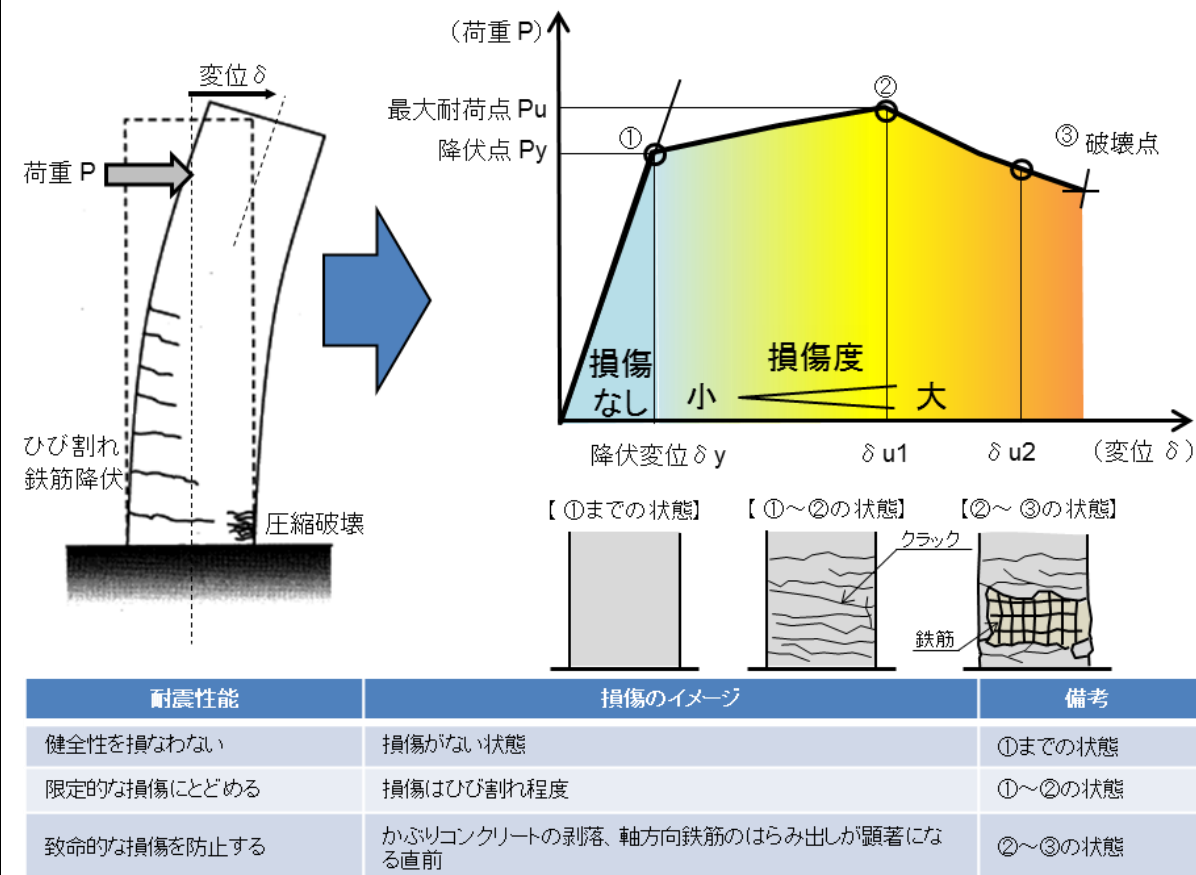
施設の損傷状態と耐震性能のイメージ【鉄筋コンクリート部材(曲げ破壊型の場合)】
